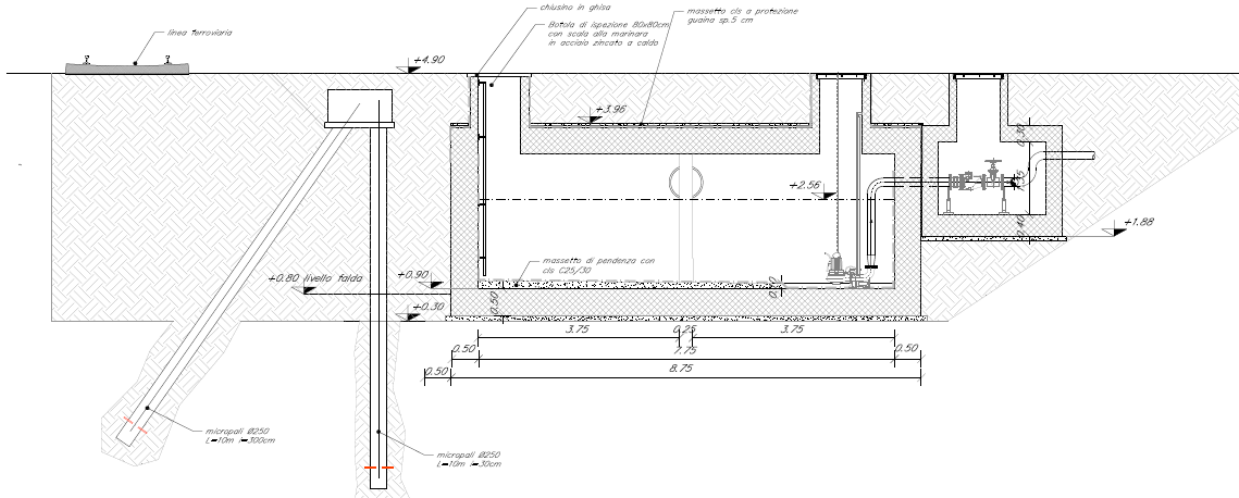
Sezione vasca di laminazione con impianto di sollevamento
